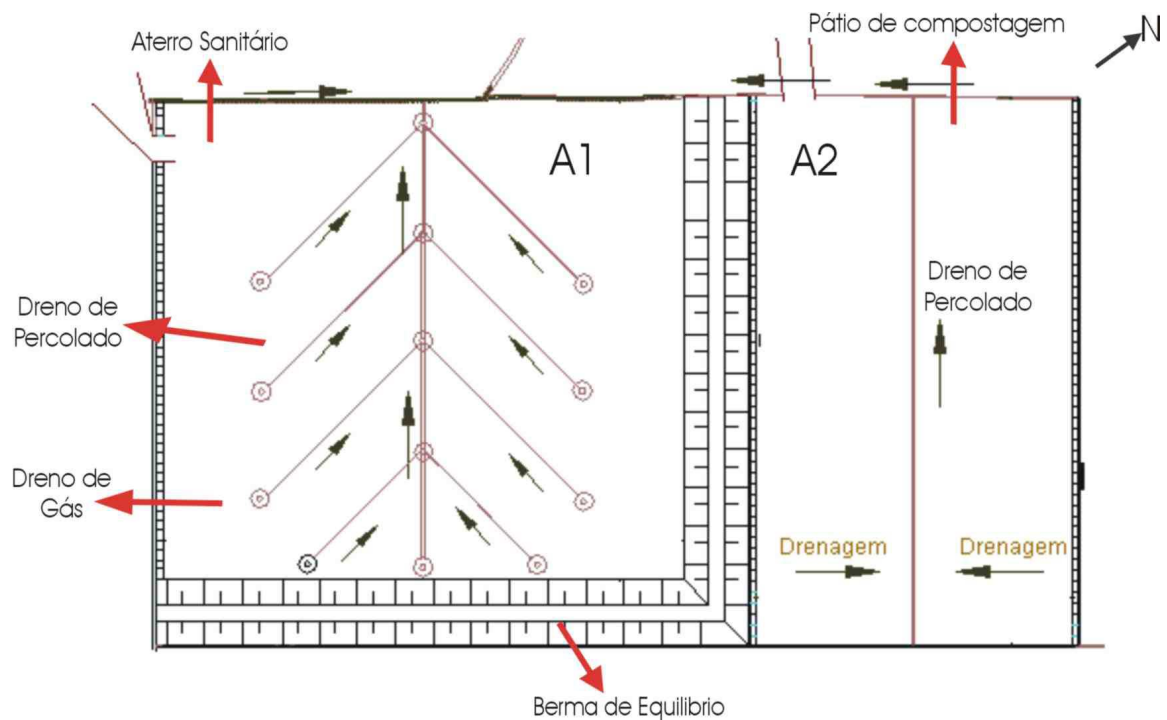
Esquema da planta baixa do Aterro Sanitário (A1) e Pátio de Compostagem (A2) da UTCAR.
